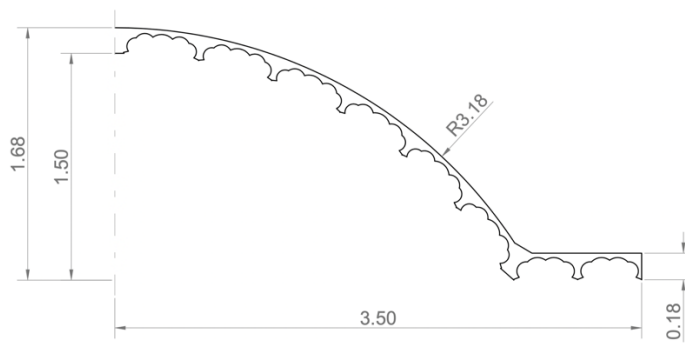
Plano de la sección de la dovela modelada, cotas en m
